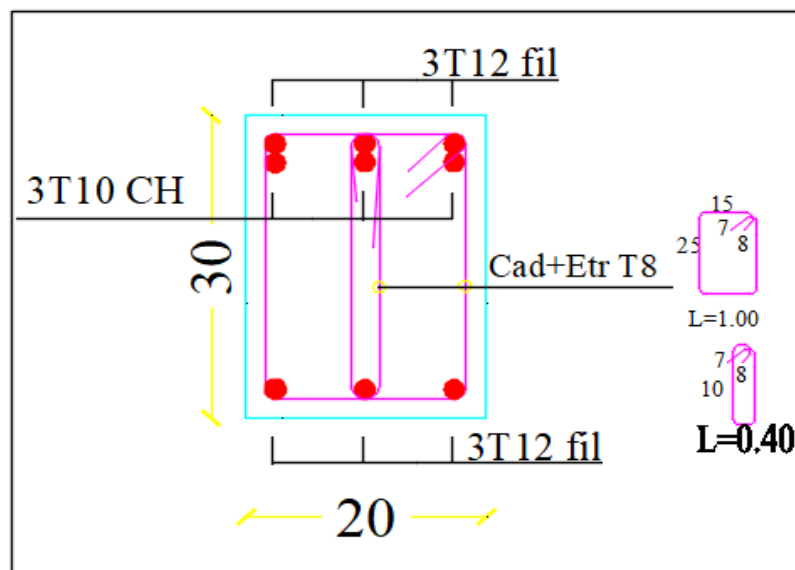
Ferrailage aux appuis d'une poutre secondaire.
